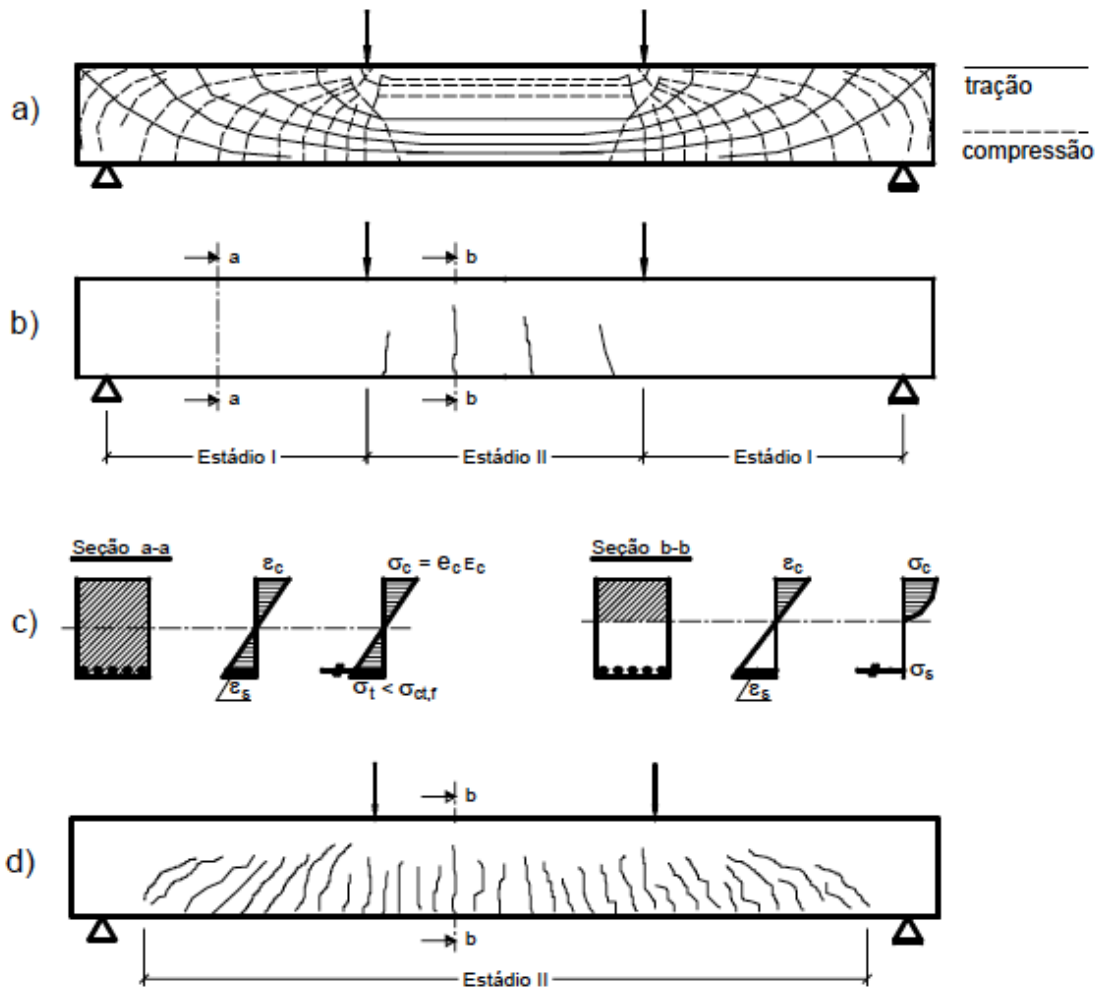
Comportamento de uma Viga Biapoiada.
